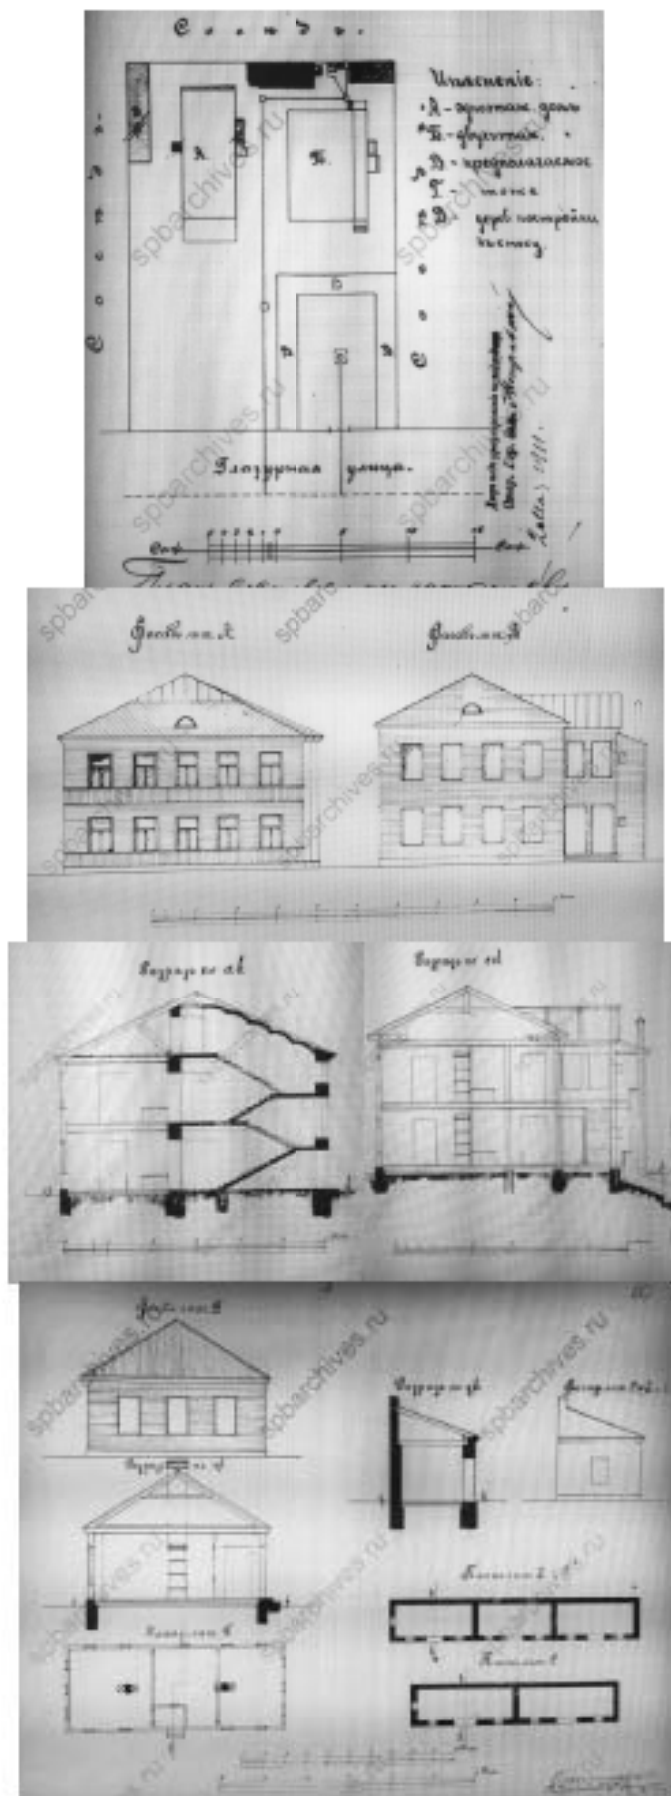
Участок по адресу Глазурная ул., 17, план участка, фасад и разрезы зданий
